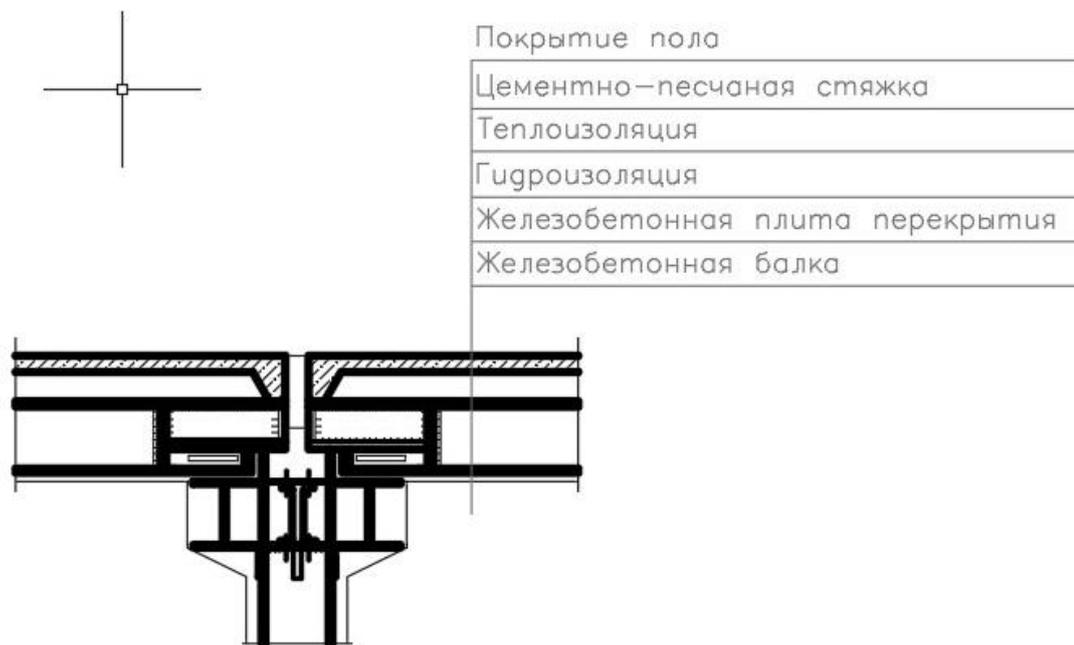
Узел примыкания железобетонных плит перекрытия с колонной
